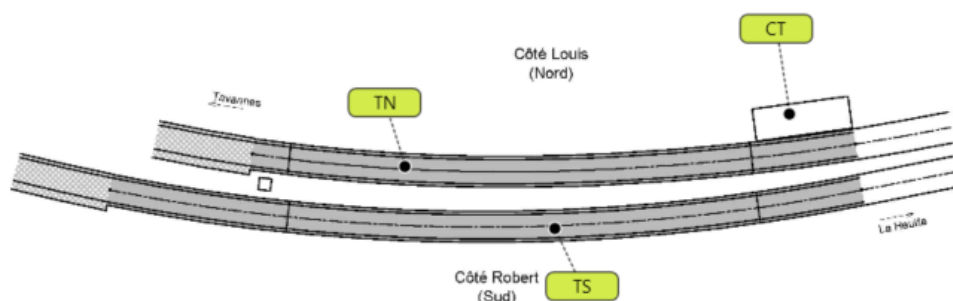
Schritt 1, Situation der Tagbautunnelanlage "Sous les Roches" mit Darstellung der Hauptinfrastrukturobjekte
